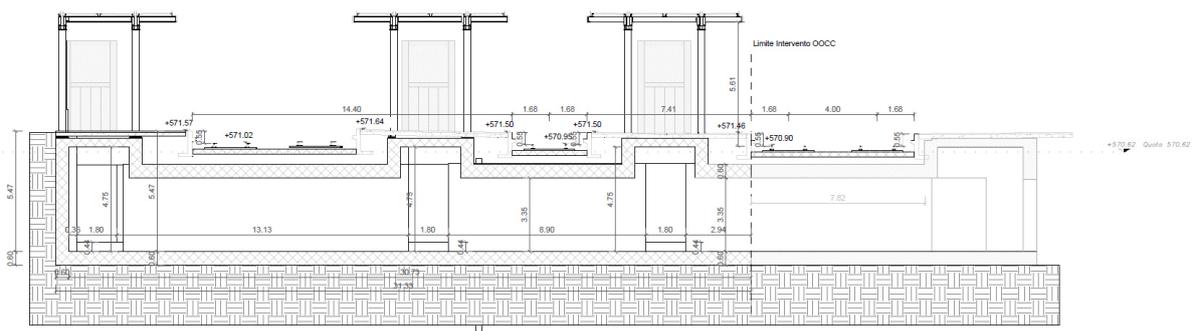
Nuovo sottopasso di stazione SL02 – Pianta
